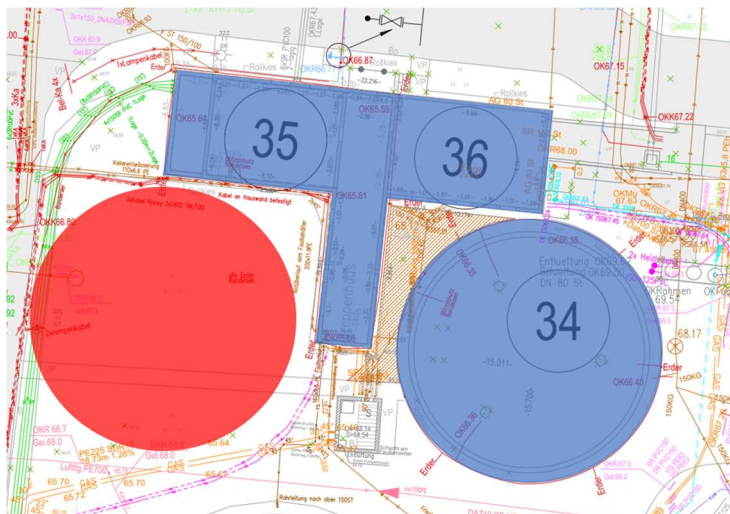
Auszug Lageplan Bestand (blau) und Neubau (rot)
